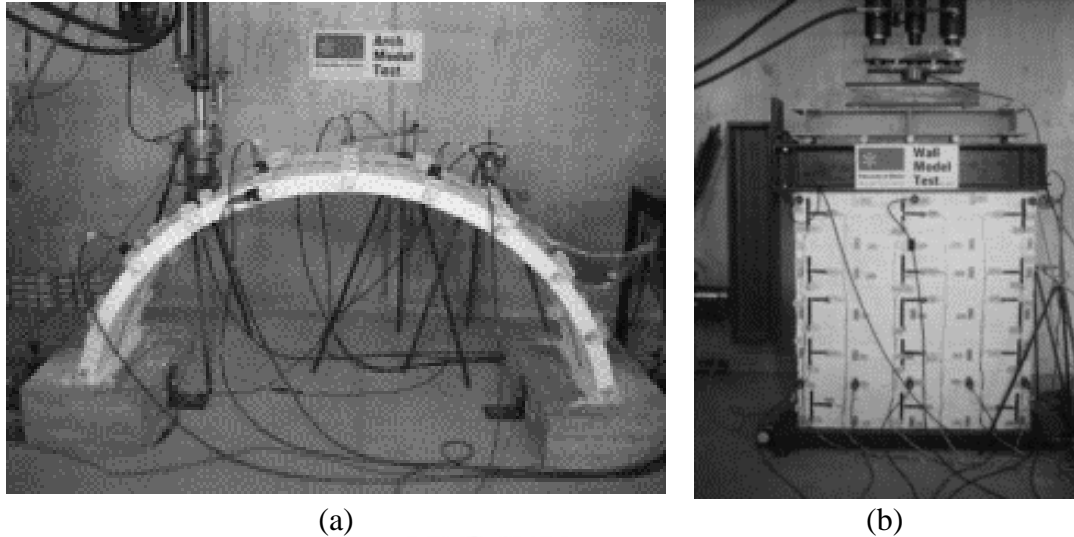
Réplicas de estructuras históricas de mampostería para la detección de daño: (a) arco y (b) muro (Luís F Ramos et al., 2006)
